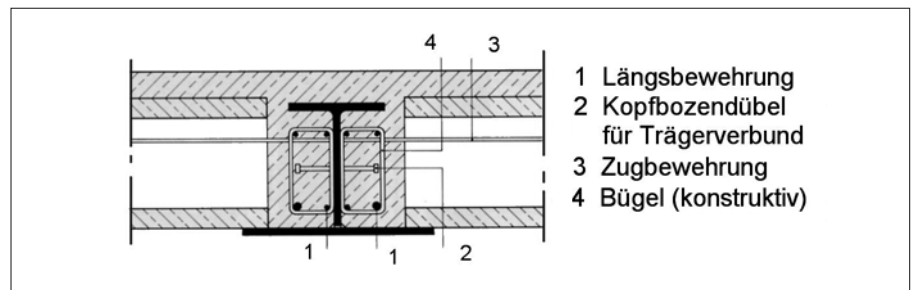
Flachdeckenträger mit integriertem Brandschutz
